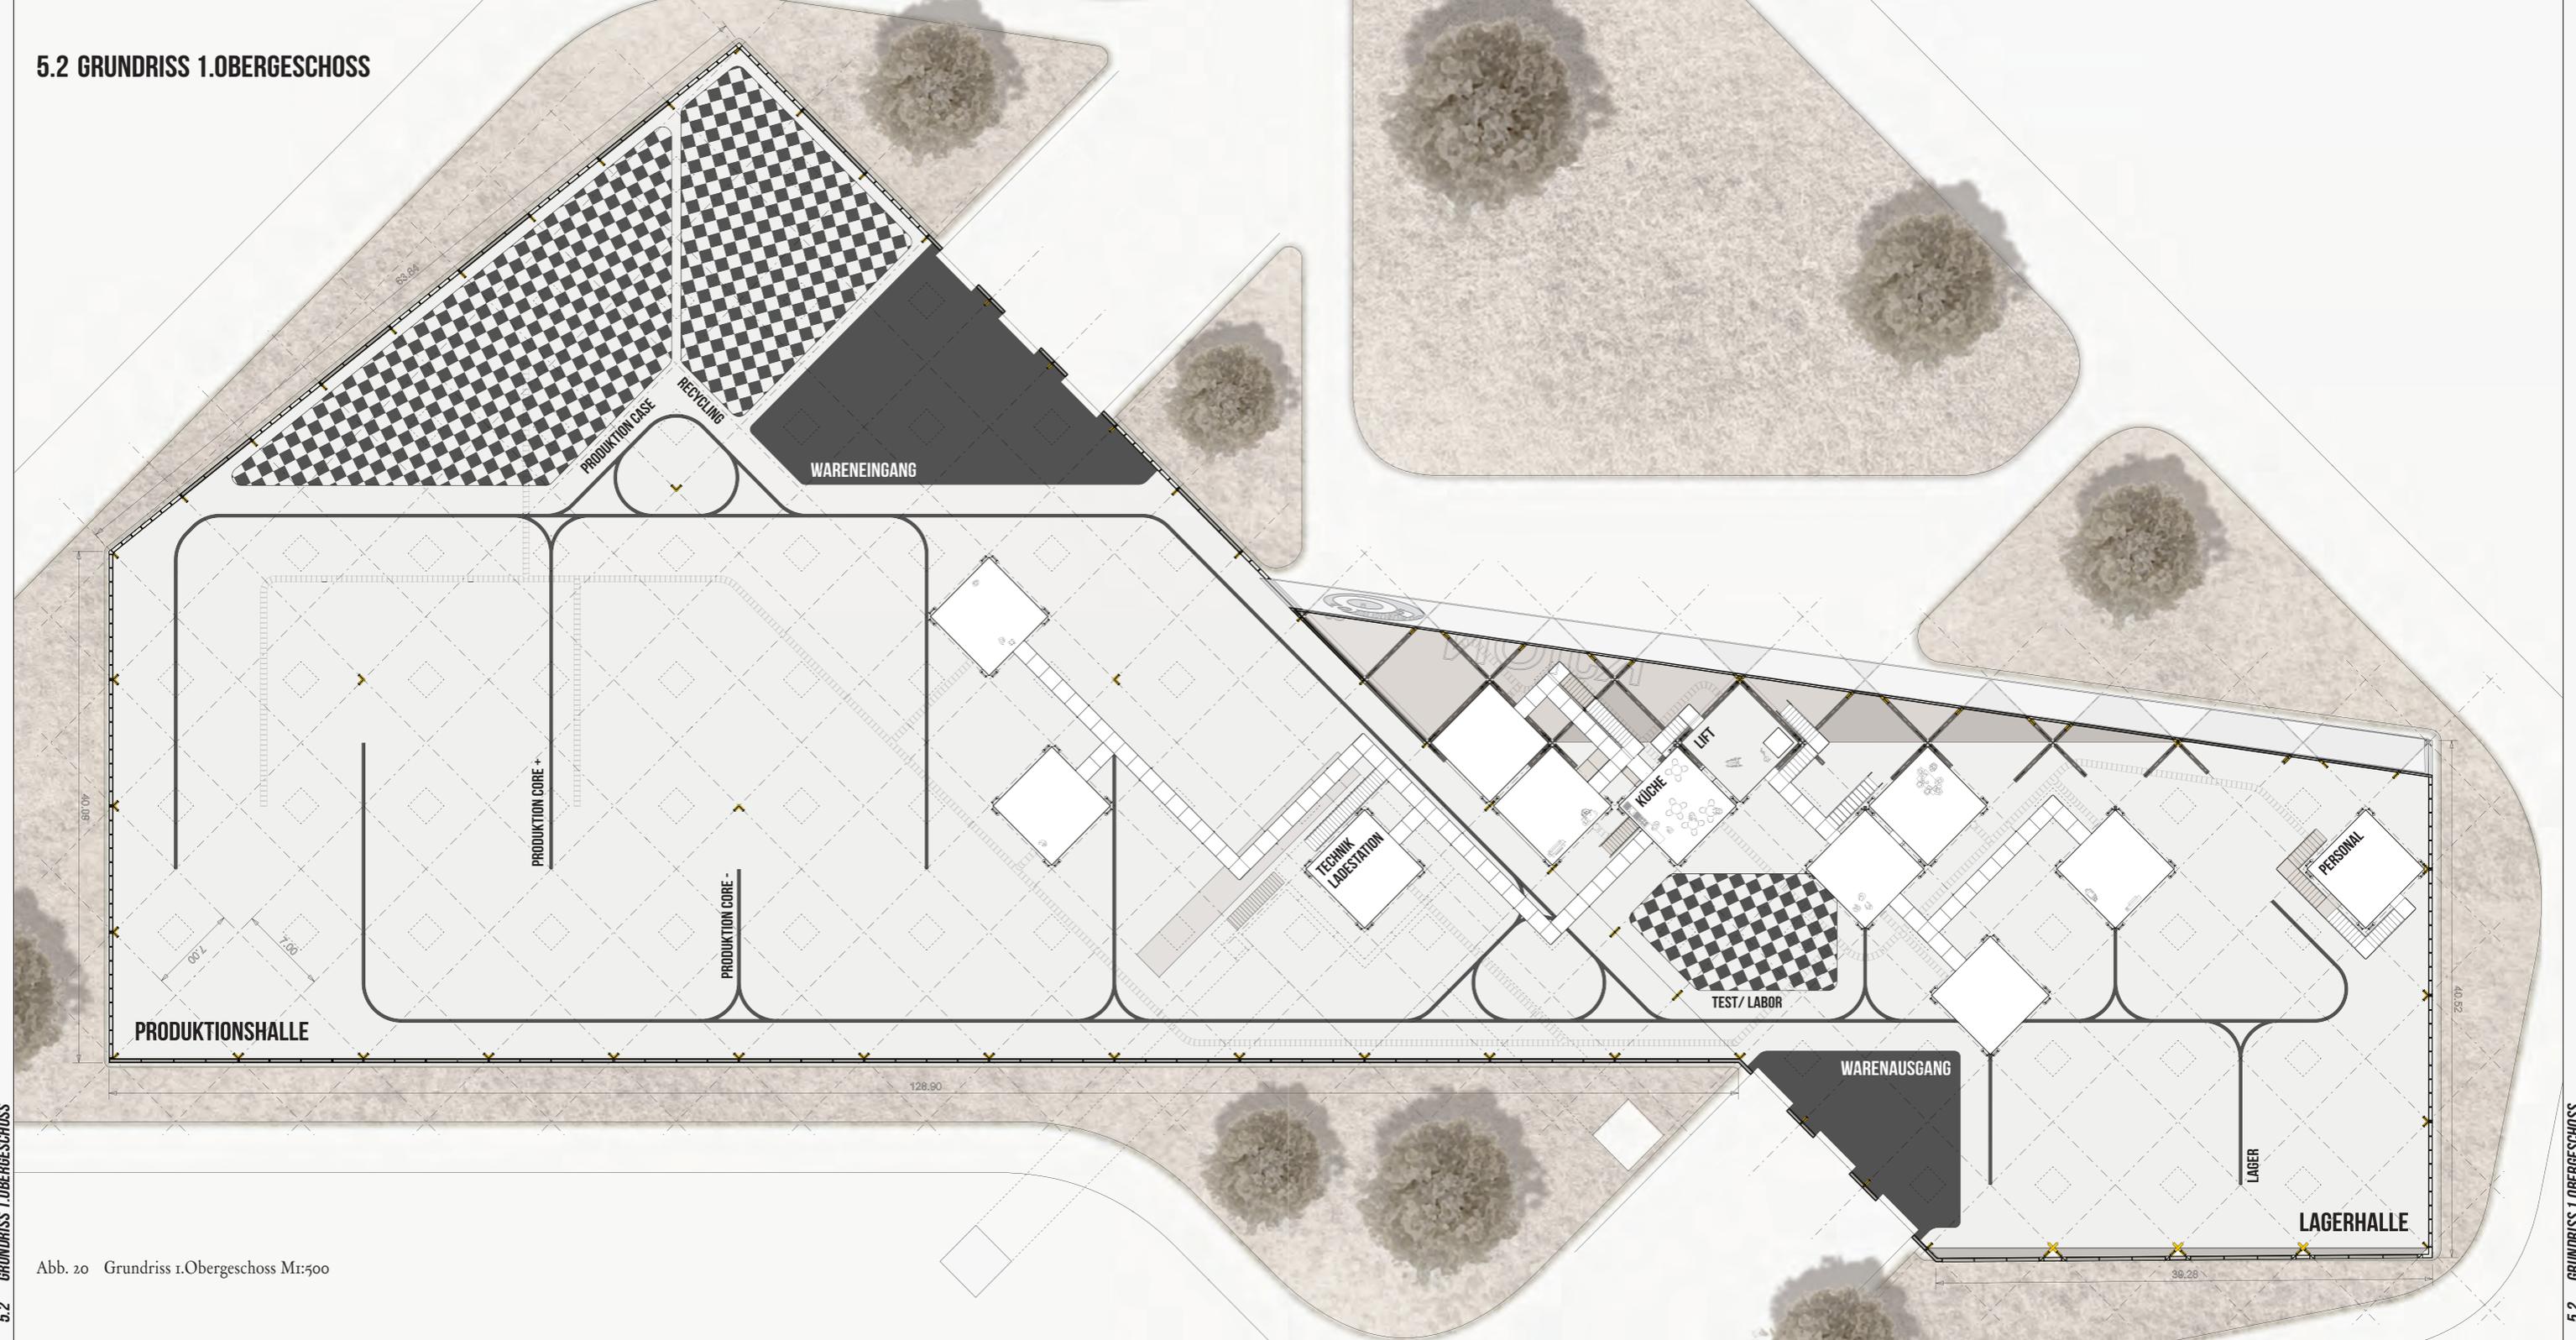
Grundriss 1.Obergeschoss M1:500
